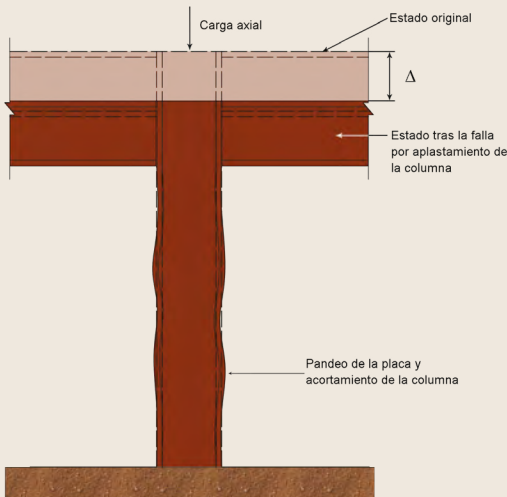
a Falla por aplastamiento de una columna de acero.
